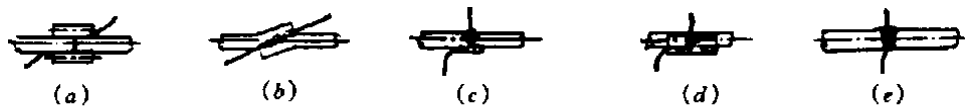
钢筋电弧焊接头拉伸试验断于焊缝示意图
